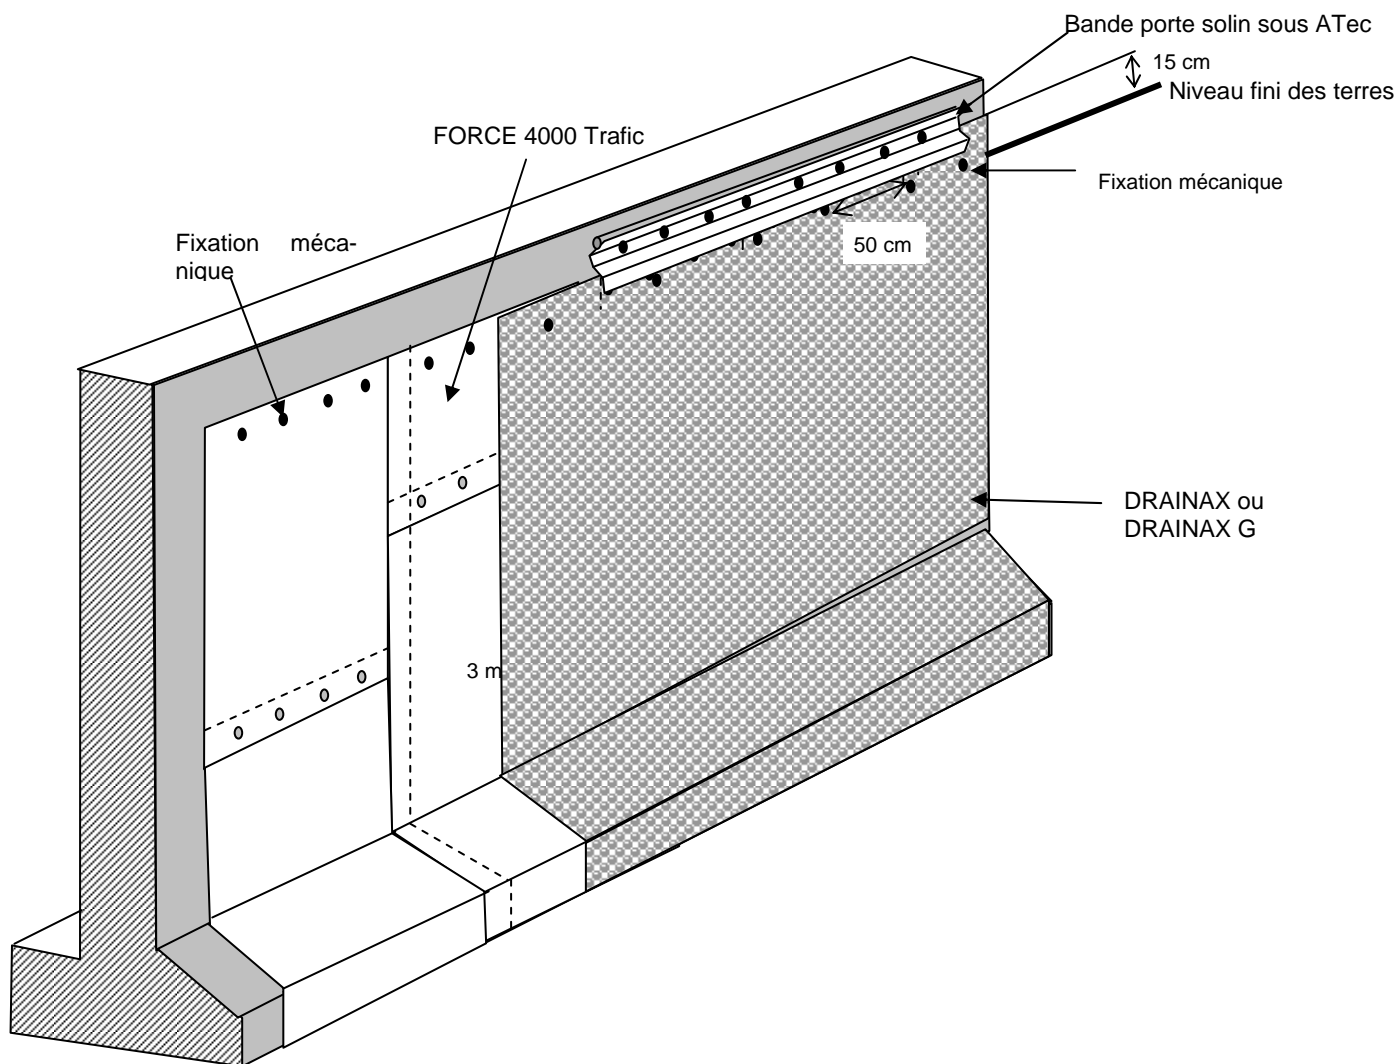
Exemple de mise en œuvre du DRAINAX / DRAINAX G sur revêtement d'étanchéité pour $h < 2$ m
